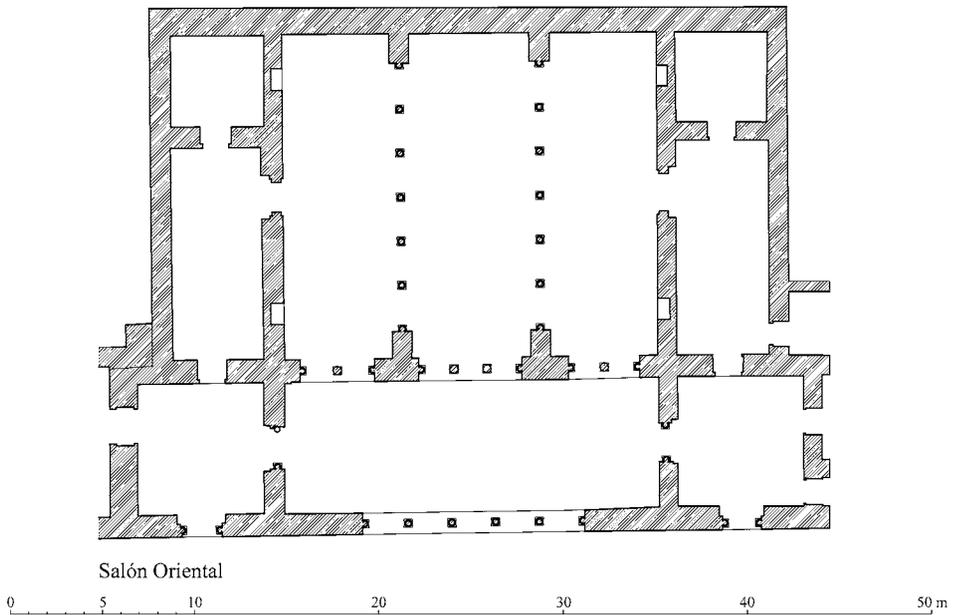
Planta del Salón Oriental de Madīnat al-Zahrā' [Plan of the Eastern Hall de Madīnat al-Zahrā'].
